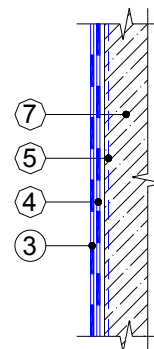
Конструктивное решение по устройству вертикальной гидроизоляции
